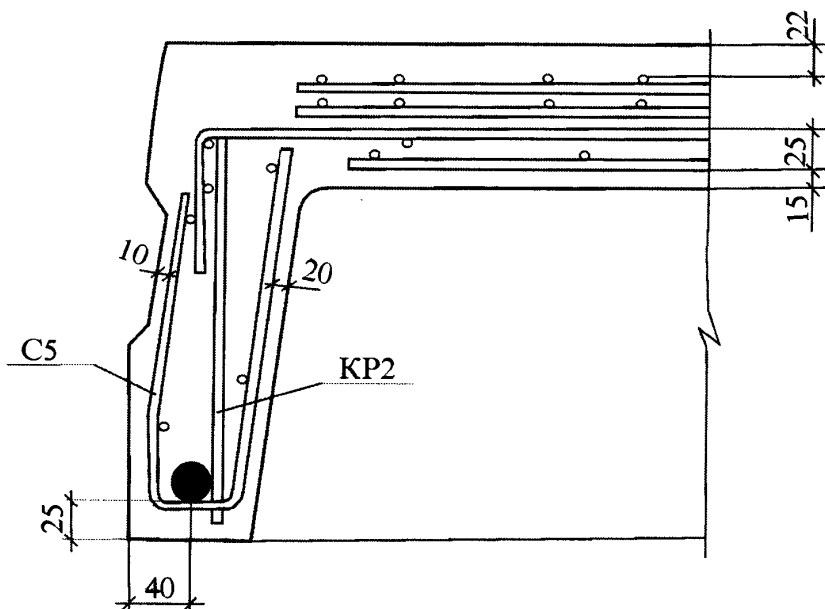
Фрагмент поперечного сечения ребристой железобетонной плиты перекрытия (к примеру 1)
